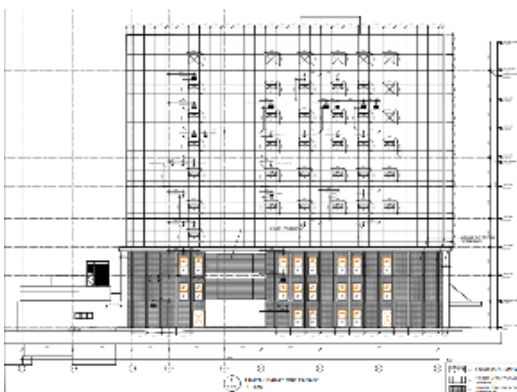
Tampak Depan Bangunan Gedung Onkologi
